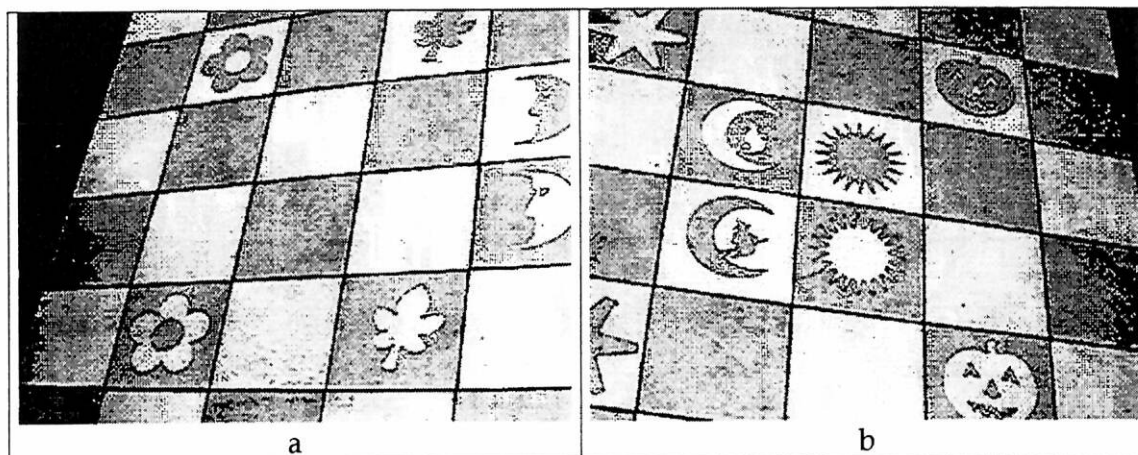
Duas vistas da calçada construída com ladrilhos cortados com jato abrasivo.
